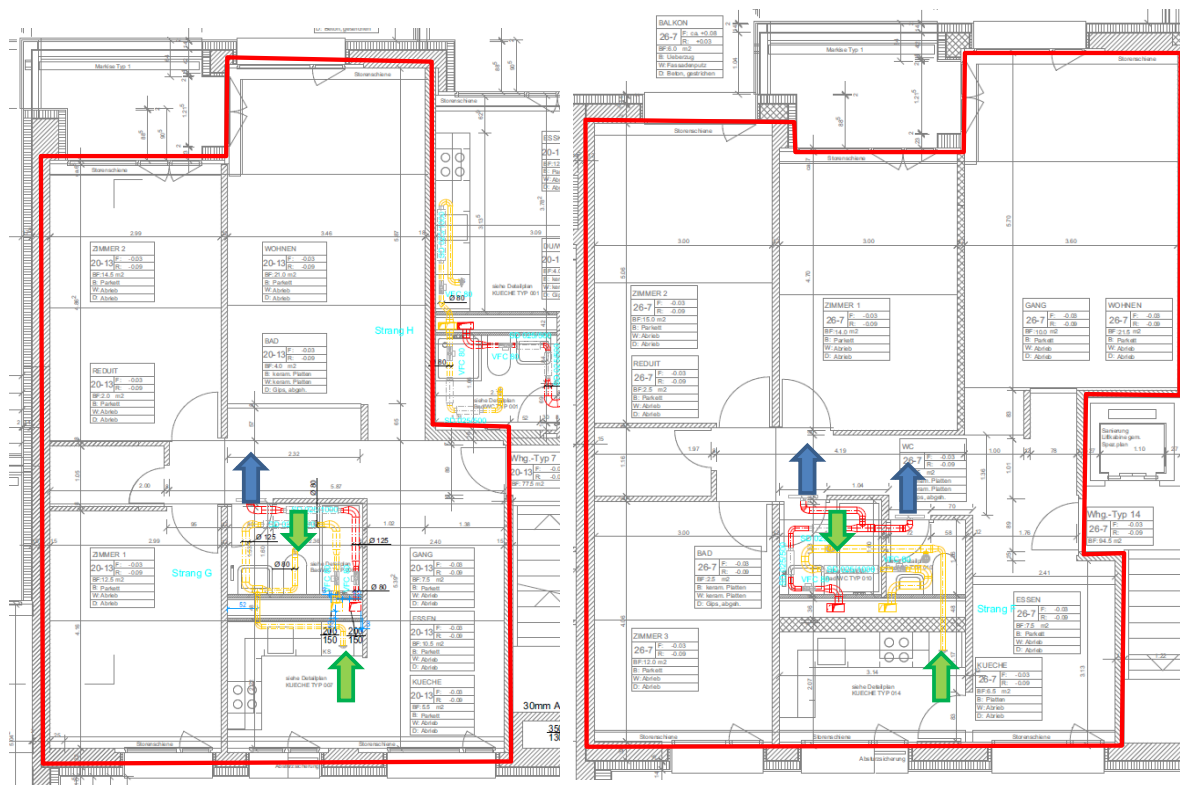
Planansatz typischer Grundriss einer 3.5 und 4.5-Zi-WNG (Bildquelle: Amt für Hochbauten 2017)
